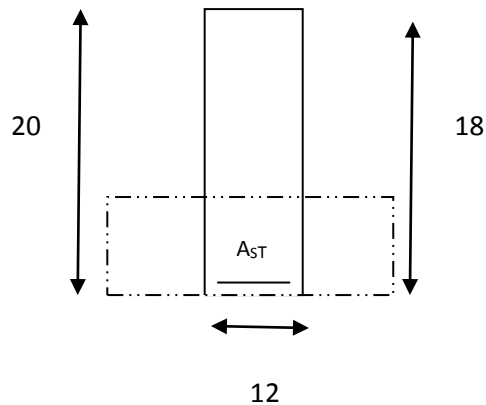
section de calcul de la poutrelle aux appuis
